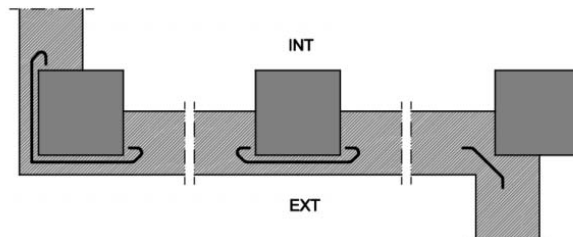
Ejemplo de encuentro de la fachada con los pilares
